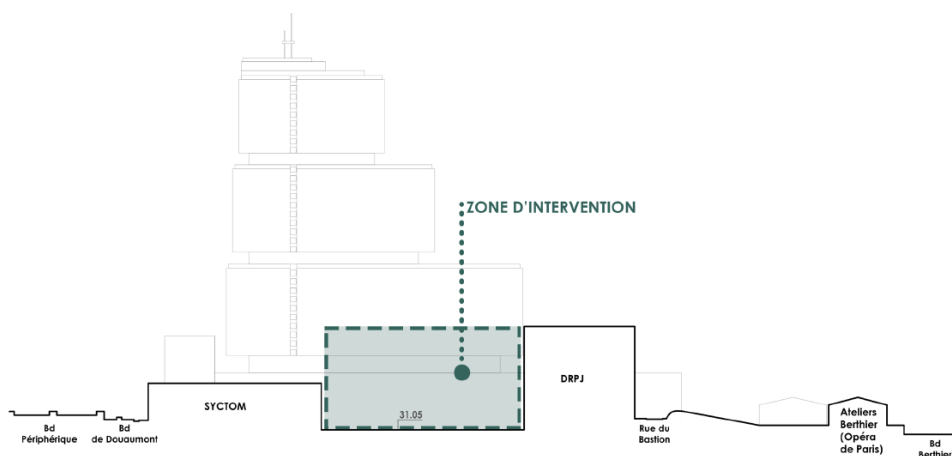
Coupe transversale de l'existant (source : DTACC)
